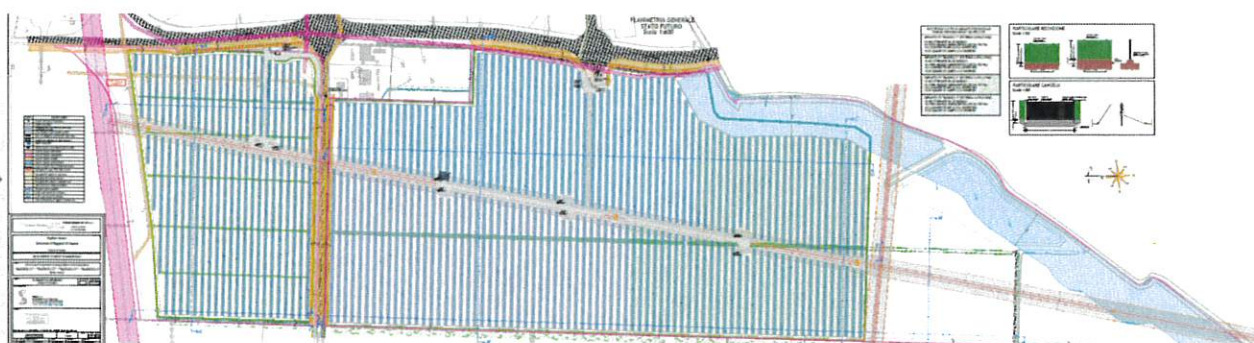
Planimetria generale – stato futuro, prima della revisione del progetto [Cfr. Elaborato 16_TAVA03_PLAN_FUT-signed]
